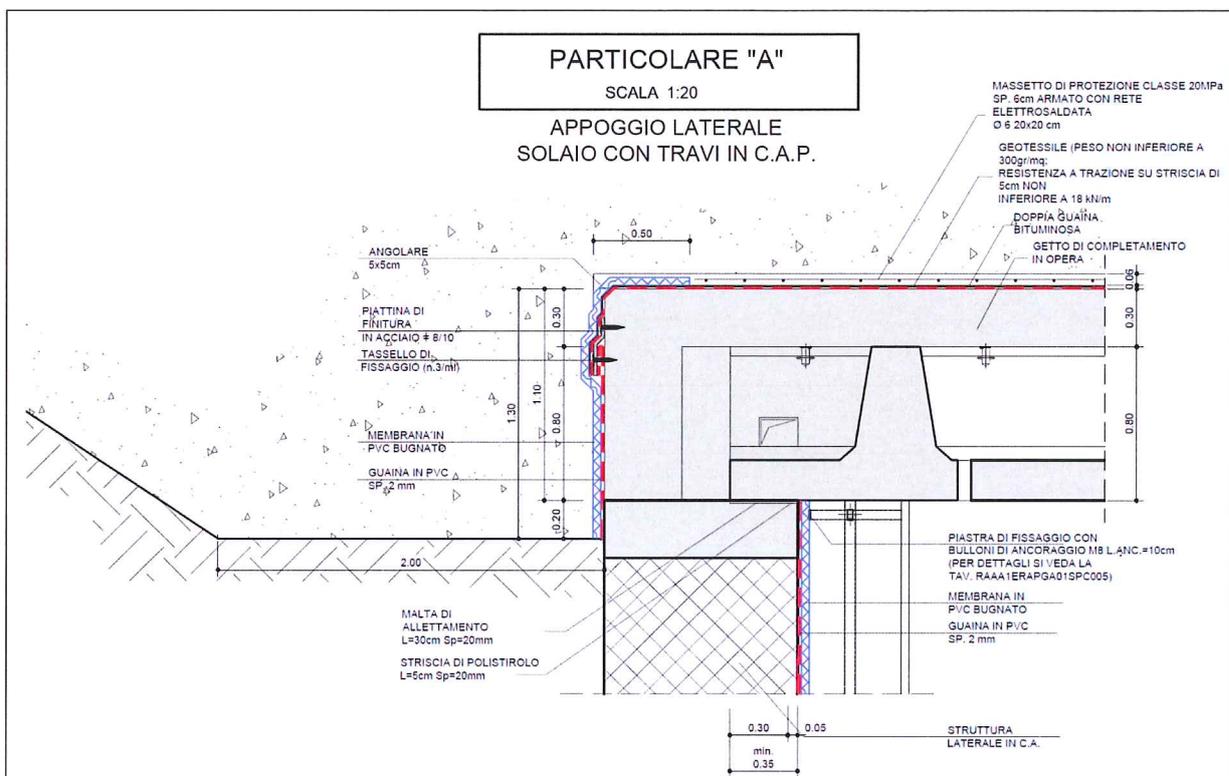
Particolare impermeabilizzazione risolto su travi prefabbricate (Sezione fra diaframmi)
